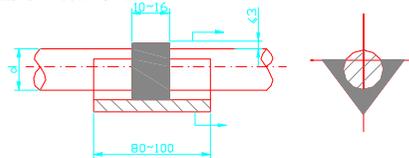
钢筋熔槽帮条焊接头
